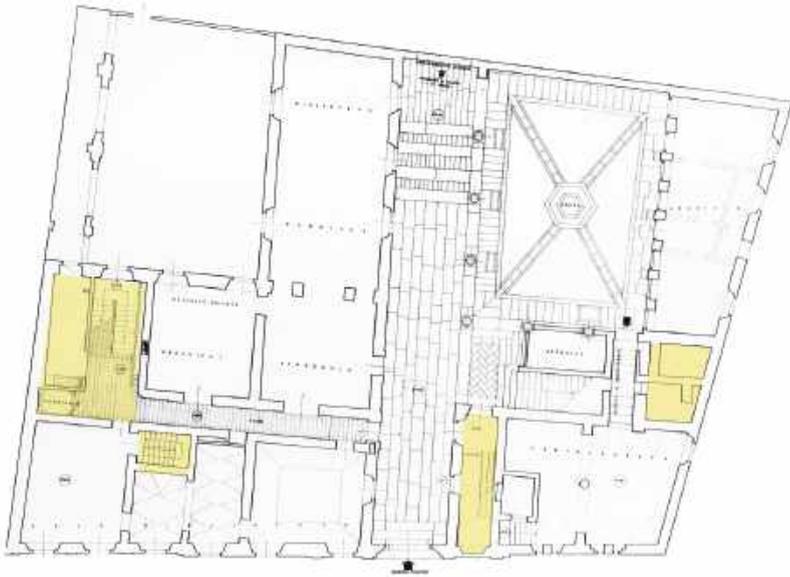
Pianta piano terra, progetto di restauro (rielaborazione, giallo-demolizioni)
